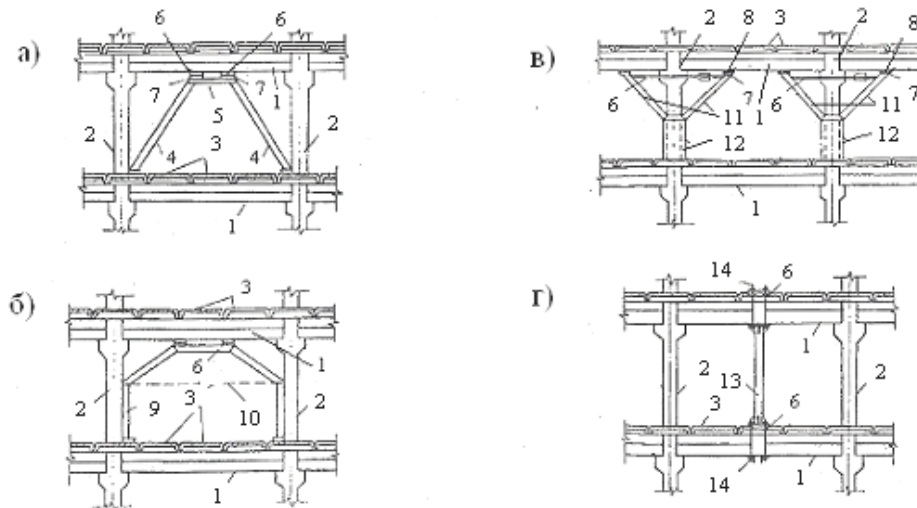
Усиление ригелей железобетонных рам многоэтажных зданий установкой подкосов (а), рам (б), полураскосов (в) и стоек между ригелями перекрытий (г)
